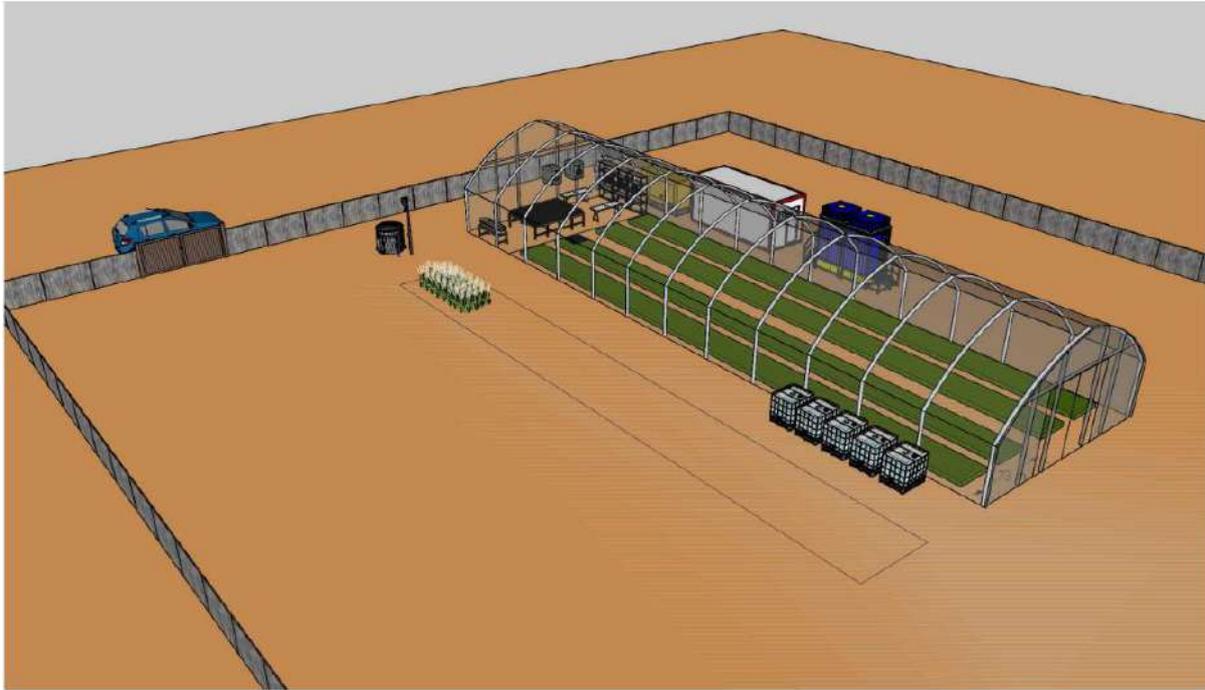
Proposition d'une vue générale de la disposition de la serre.
